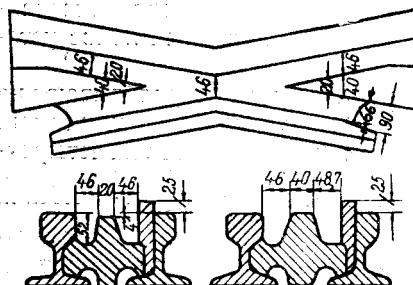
Схема тупой крестовины марки 1/9 глухого пересечения
